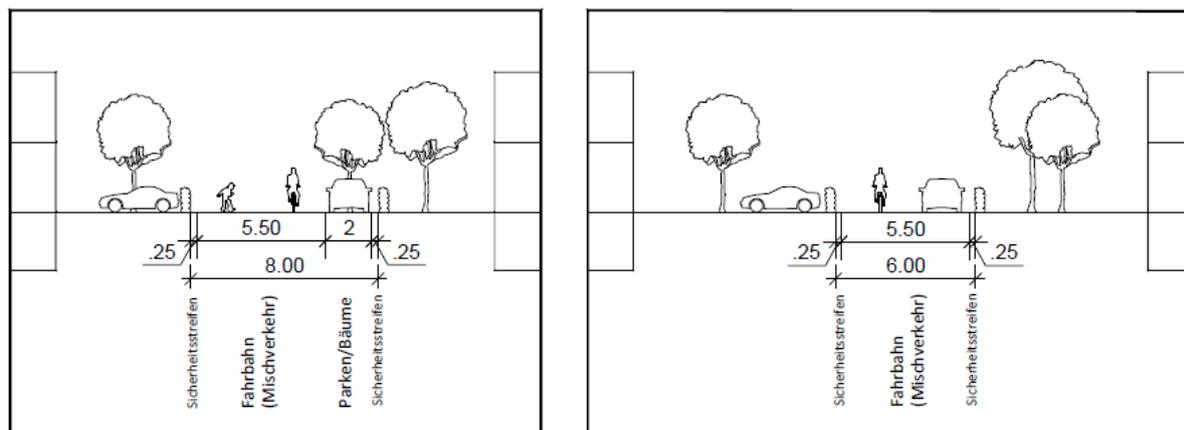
Straßenquerschnitte: Planstraße A (links) und Planstraße B (rechts), ohne Maßstab
